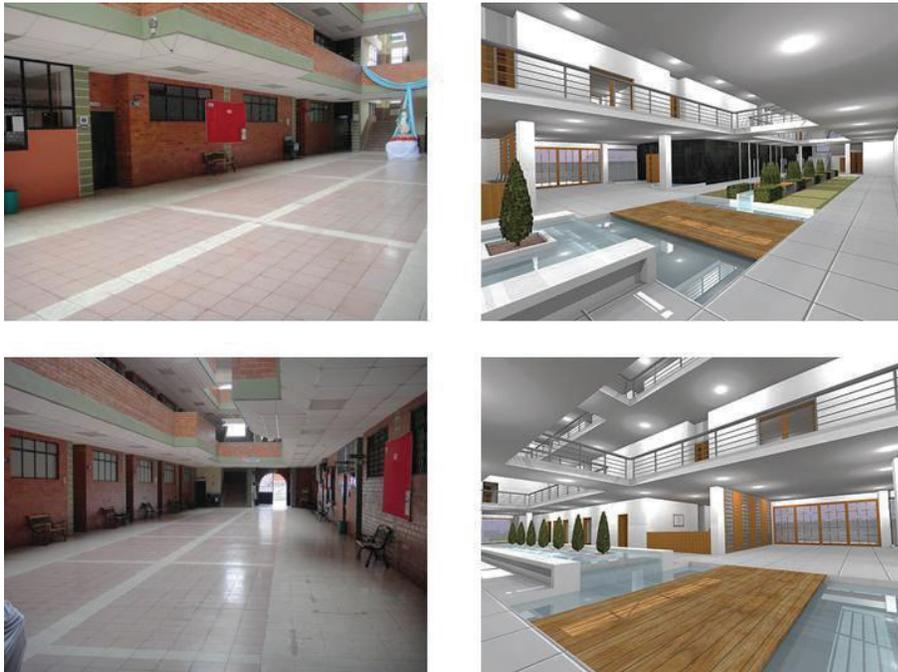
Izquierda.- Estado actual del vestíbulo de planta baja. Derecha.- Rehabilitación propuesta.
